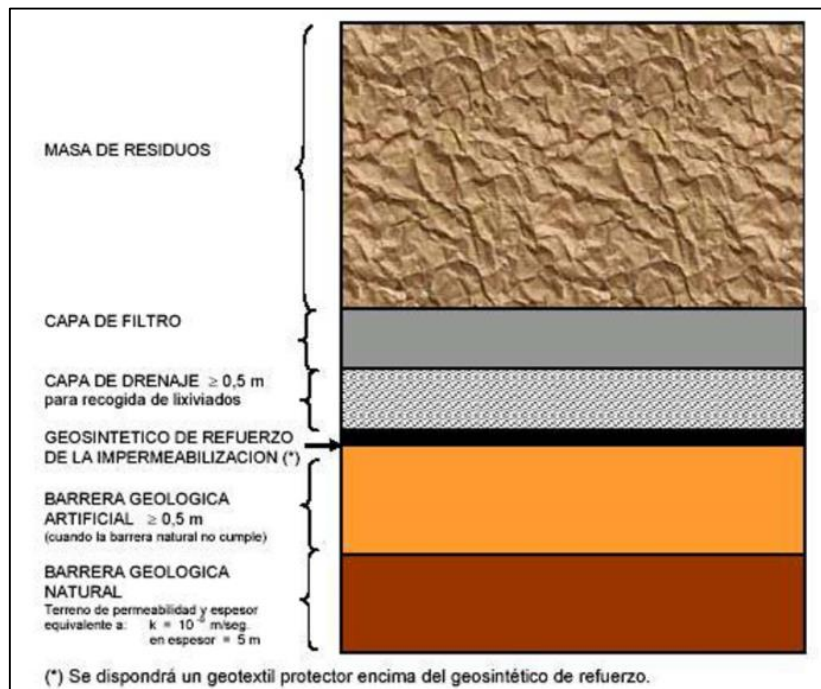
Sección celda de residuos con detalle del sistema de impermeabilización
